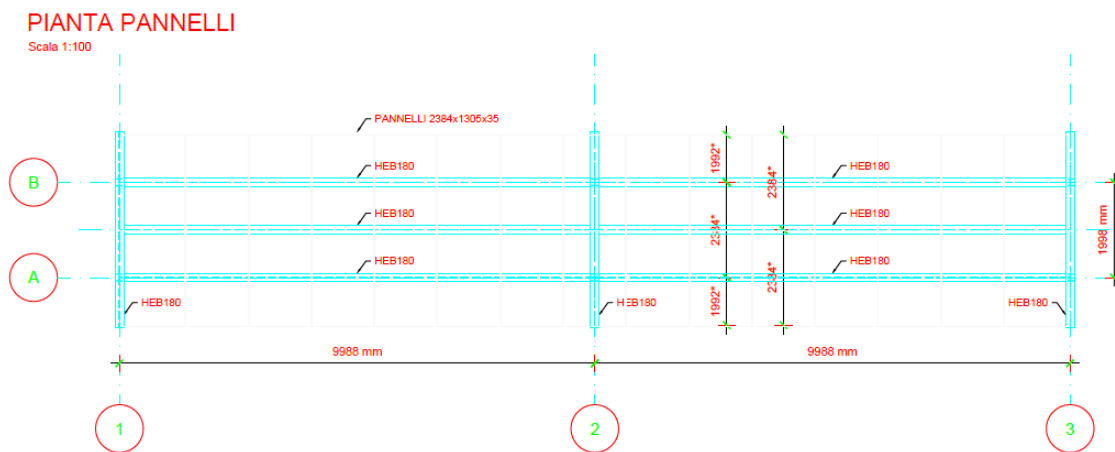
Vista in pianta della struttura "Fissa bassa (Ground Mounted T02)"
